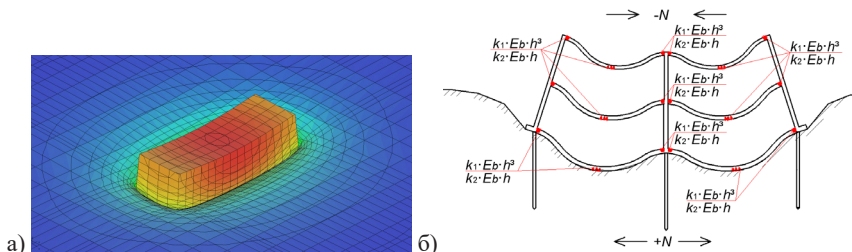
Характер деформации здания при расчете на деформируемом полупространстве (а). Схема для определения изгибной жесткости здания стеновой конструктивной схемы. Красным цветом отмечены участки трещинообразования (б)
